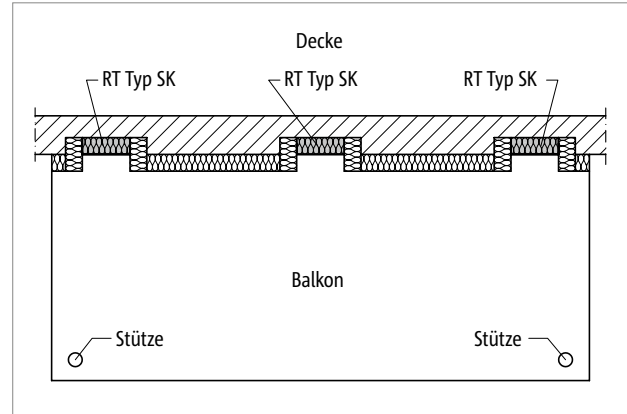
Schöck Isokorb® RT Typ SK: Anschluss eines Balkons an eine Bestandsdecke, gestützte Konstruktion
